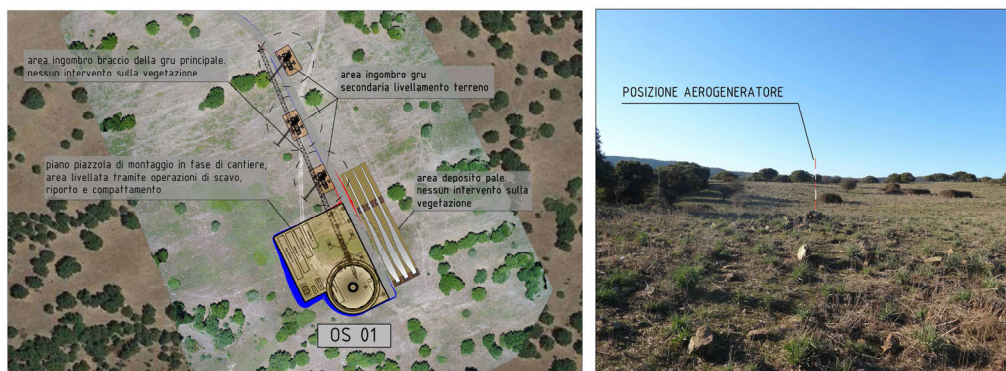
ingombri di cantiere su foto area e foto wtg OS 01
